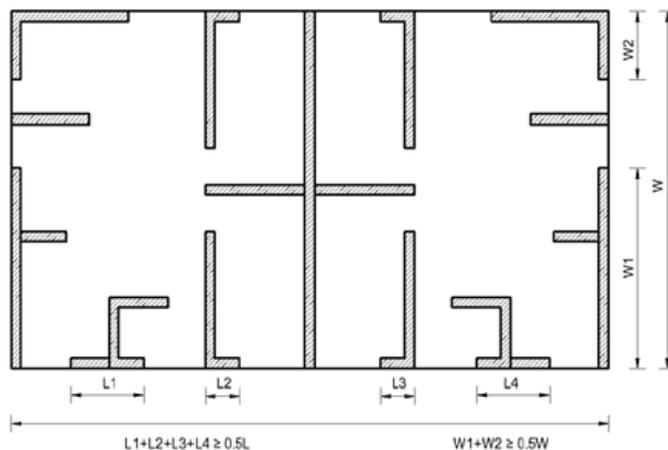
Distribución de muros mampostería confinada en dos direcciones
